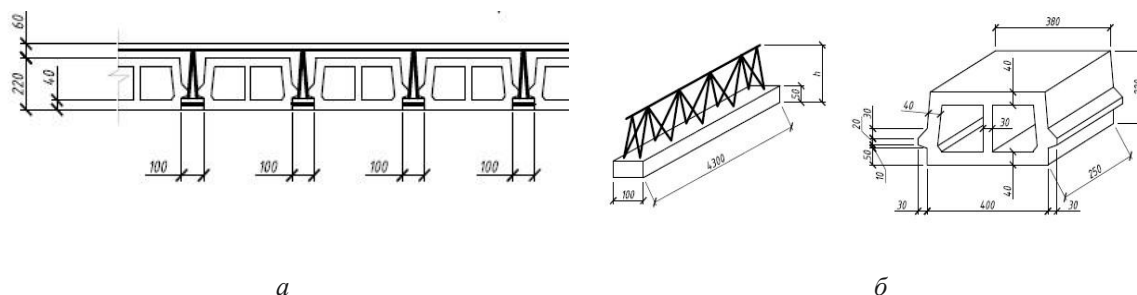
Переkritтя зі збірних залізобетонних балок із вкладишами з шлакоблоків:
